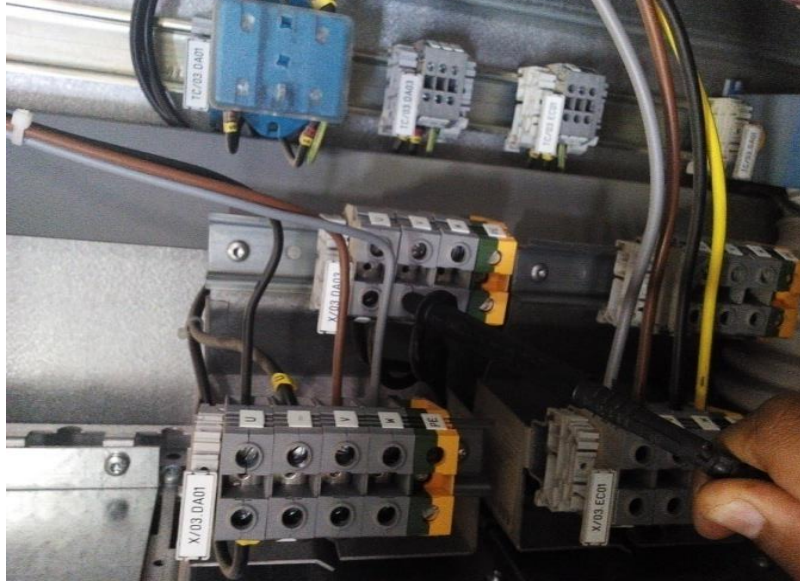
Test d'isolement du câble par rapport à la terre S/E
